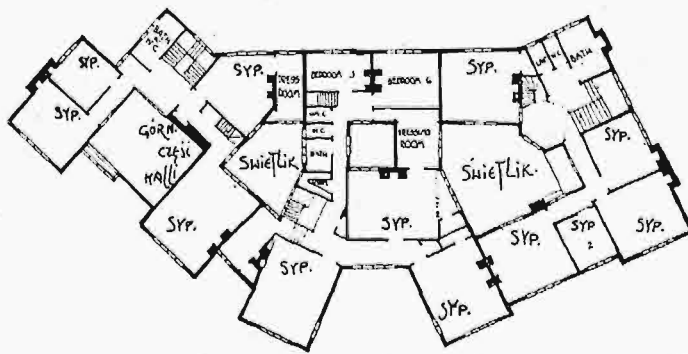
Plan domu na jedną rodzinę (do rys. 6).
